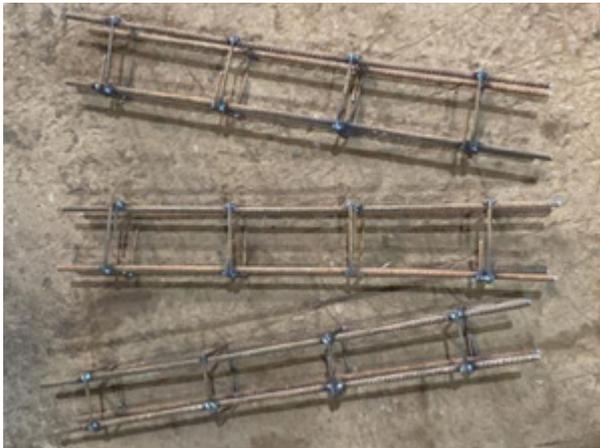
Preparo das armaduras de aço, uso de solda para fixação dos Estribos
